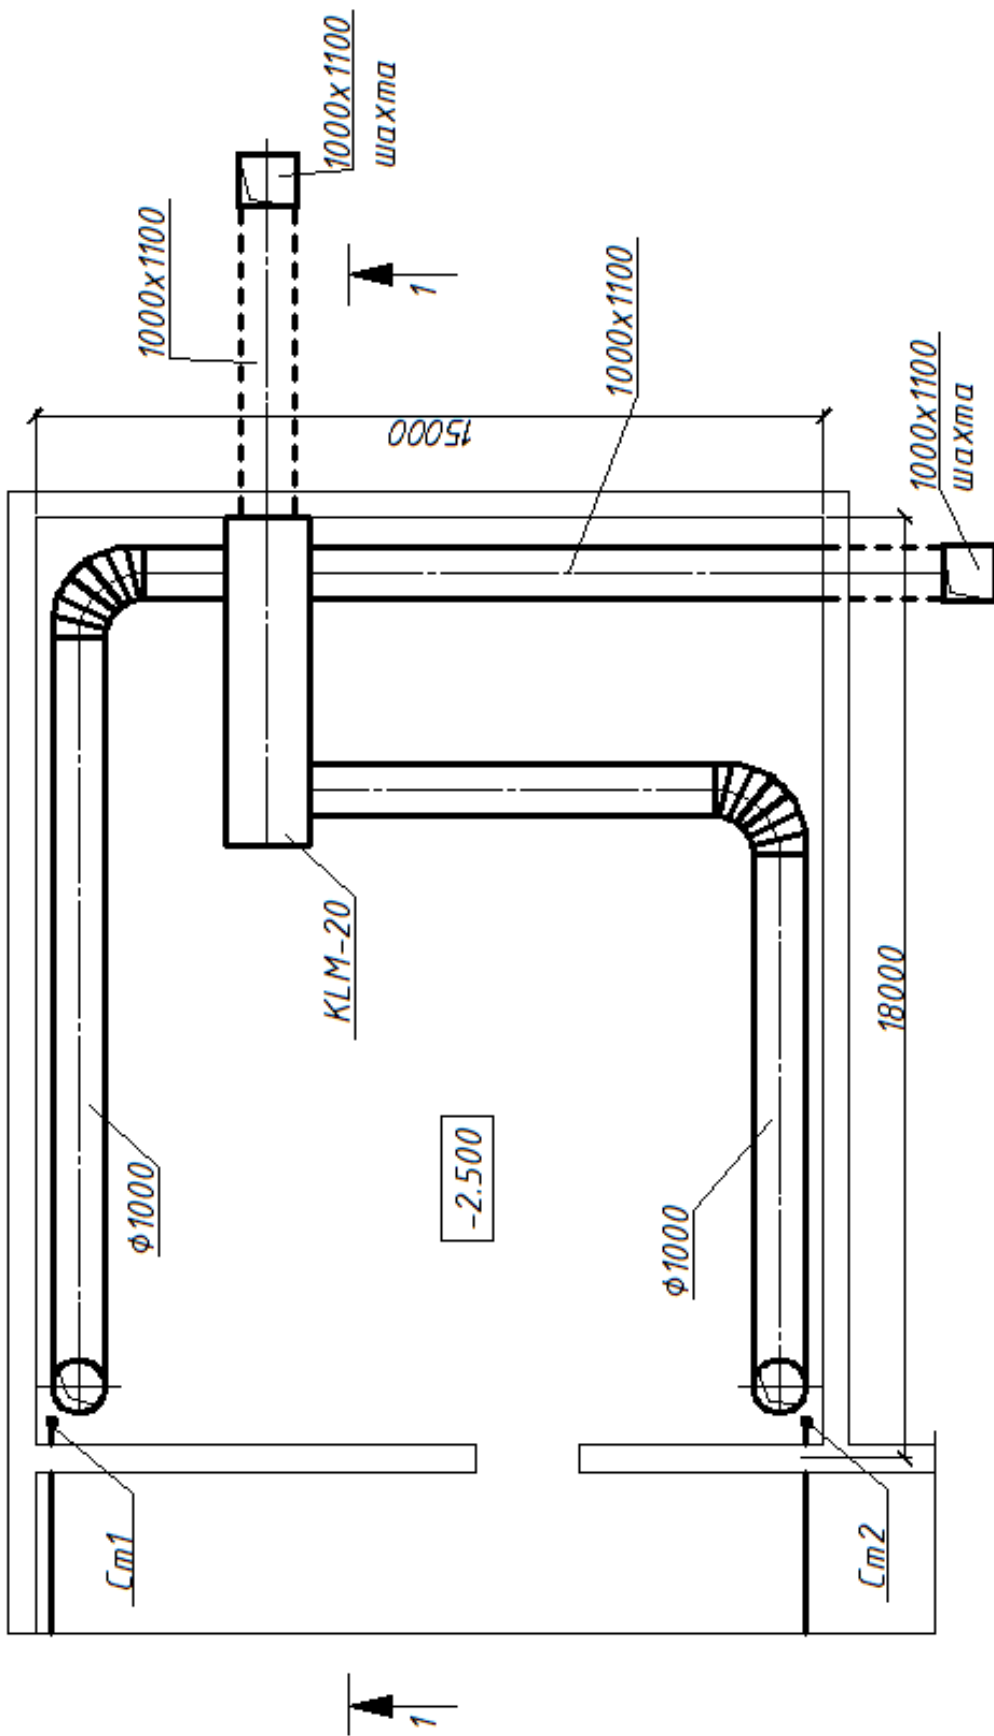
План подвала с нанесением отопительно-вентиляционного оборудования
